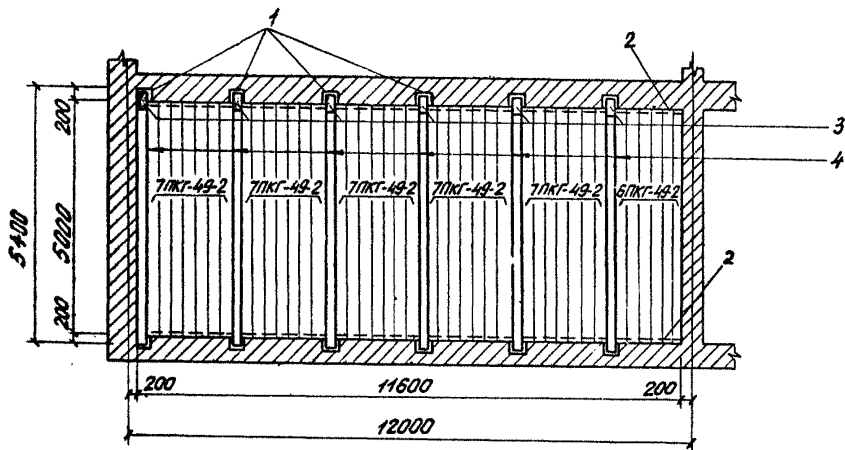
План участка перекрытия из железобетонных плит ПКГ-51-2 с опиранием на проёзы ПР-2 и плит ПКГ-49-2 с опиранием на пристенные балки МБО-1: 1 - существующие гнезда ; 2 - пристенные балки МБО-1 ; 3 - проёзы ПР-2; 4 - плиты ПКГ-51-2.
